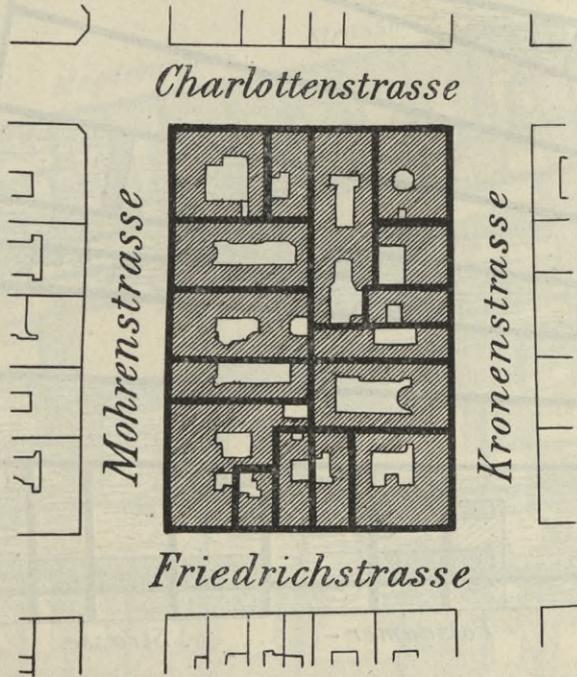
Alter Berliner Baublock der Friedrichstadt (Geschäftsviertel) in der Bebauung von 1902. Maßstab 1:2000.
